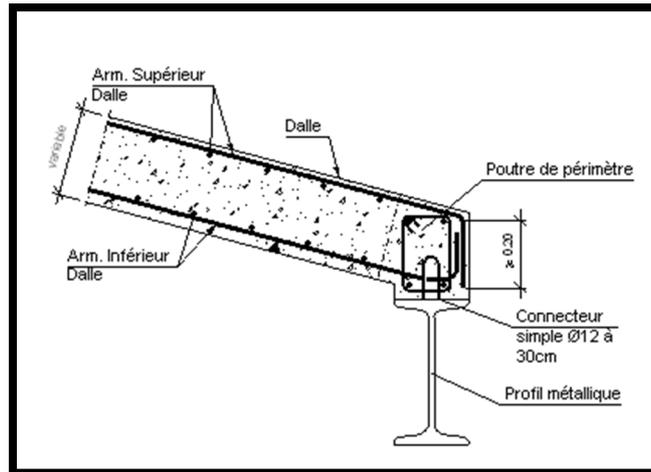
jonction poutre métallique et dalle pleine en béton armé source : <http://detailsconstructifs.cype.fr>
